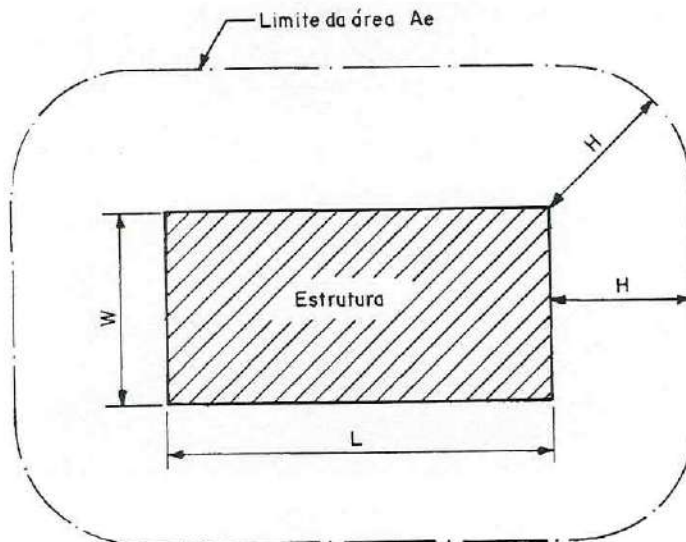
Delimitação da área de exposição equivalente (A_e) - Estrutura vista de planta
